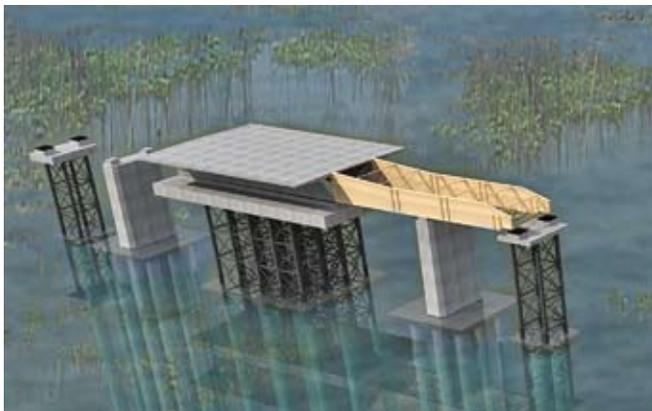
El sistema constructivo de los Viaductos, por empuje acompasado.
